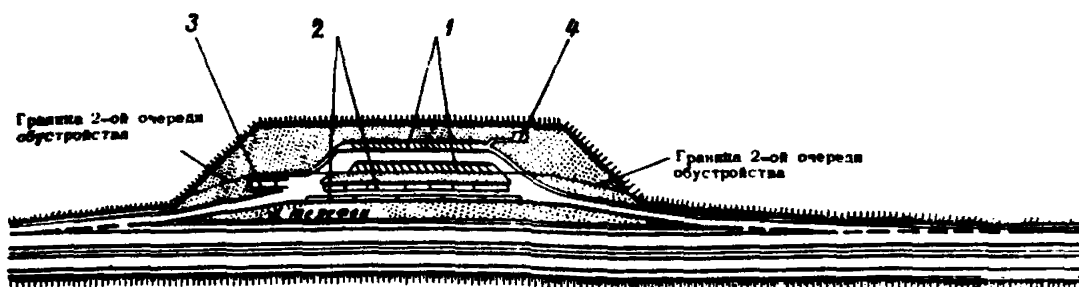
Схема площадки для стоянки на перегоне (французский вариант). Обозначения 1-4 см. рис.1
